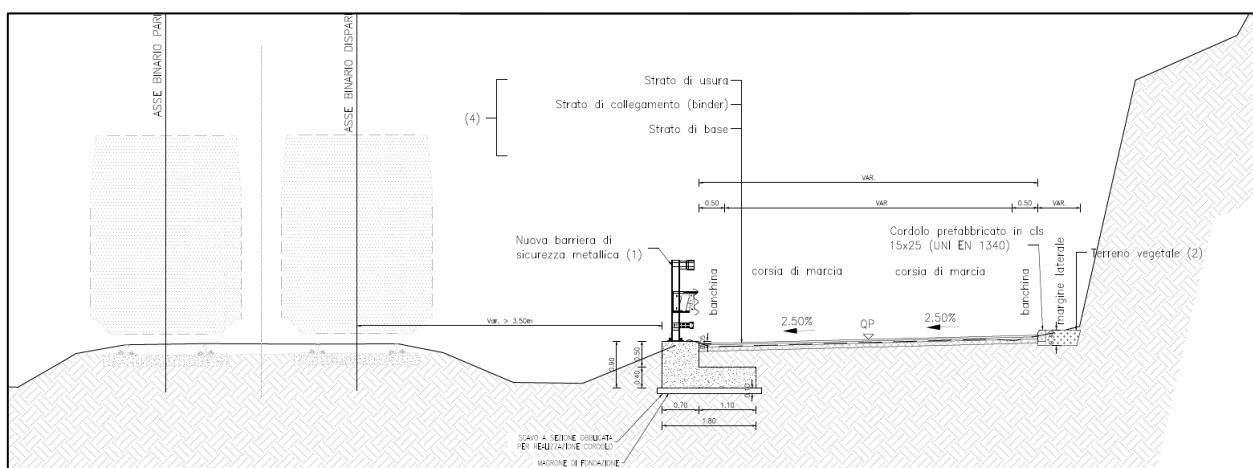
Sezione tipologica stretto affiancamento con conservazione della piattaforma stradale esistente
